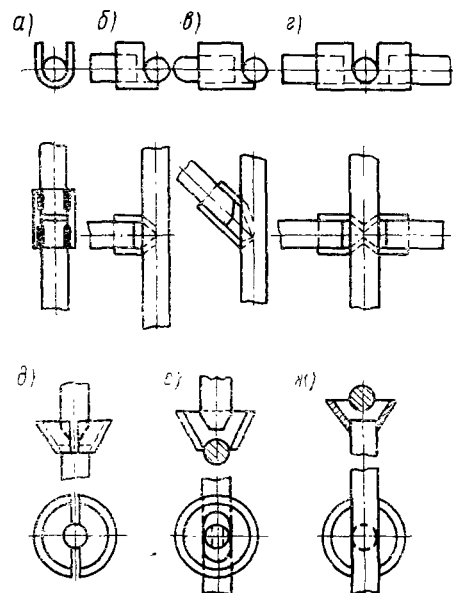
Сварные соединения арматуры, выполняемые ванным способом
